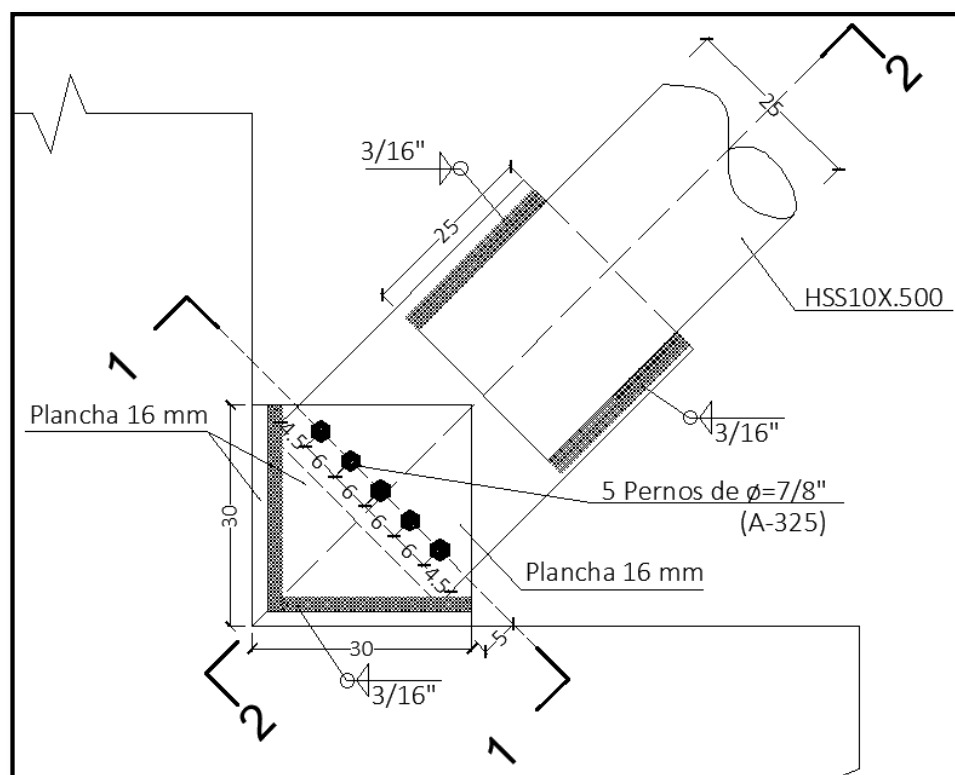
Detalle 1 Conexión de arriostre y pórtico de concreto armado.
